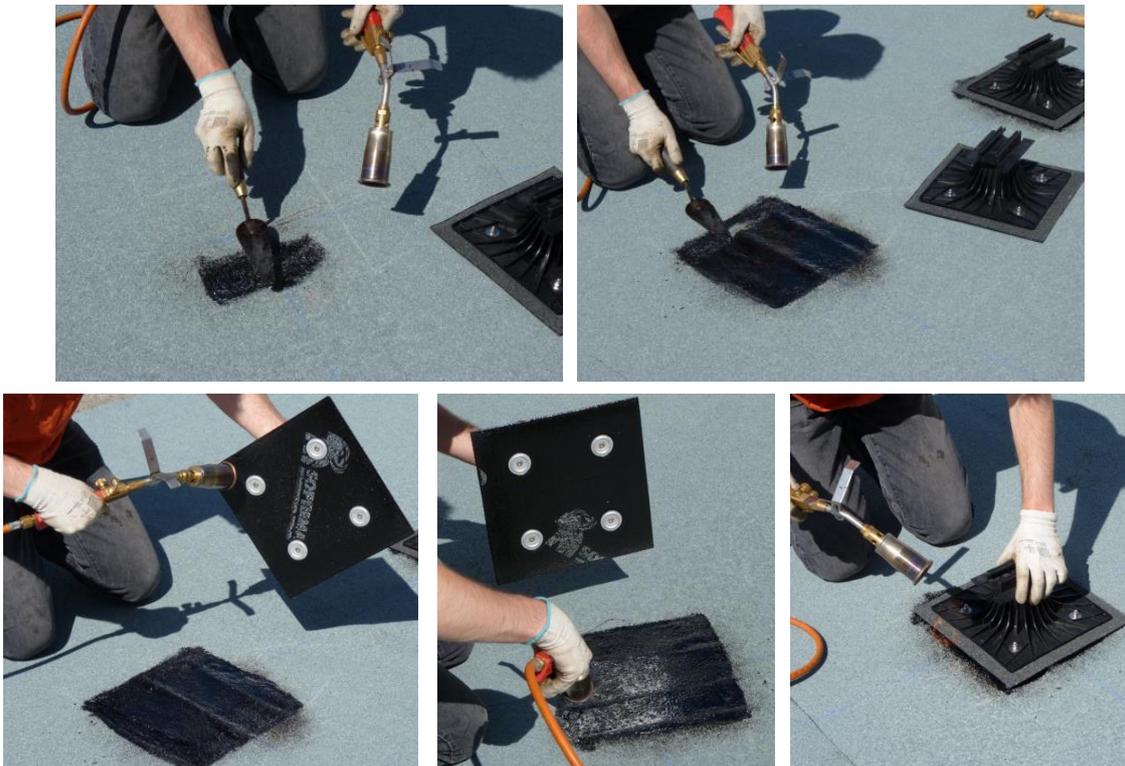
Technique de soudage des plots sur revêtement d'étanchéité ardoisée
